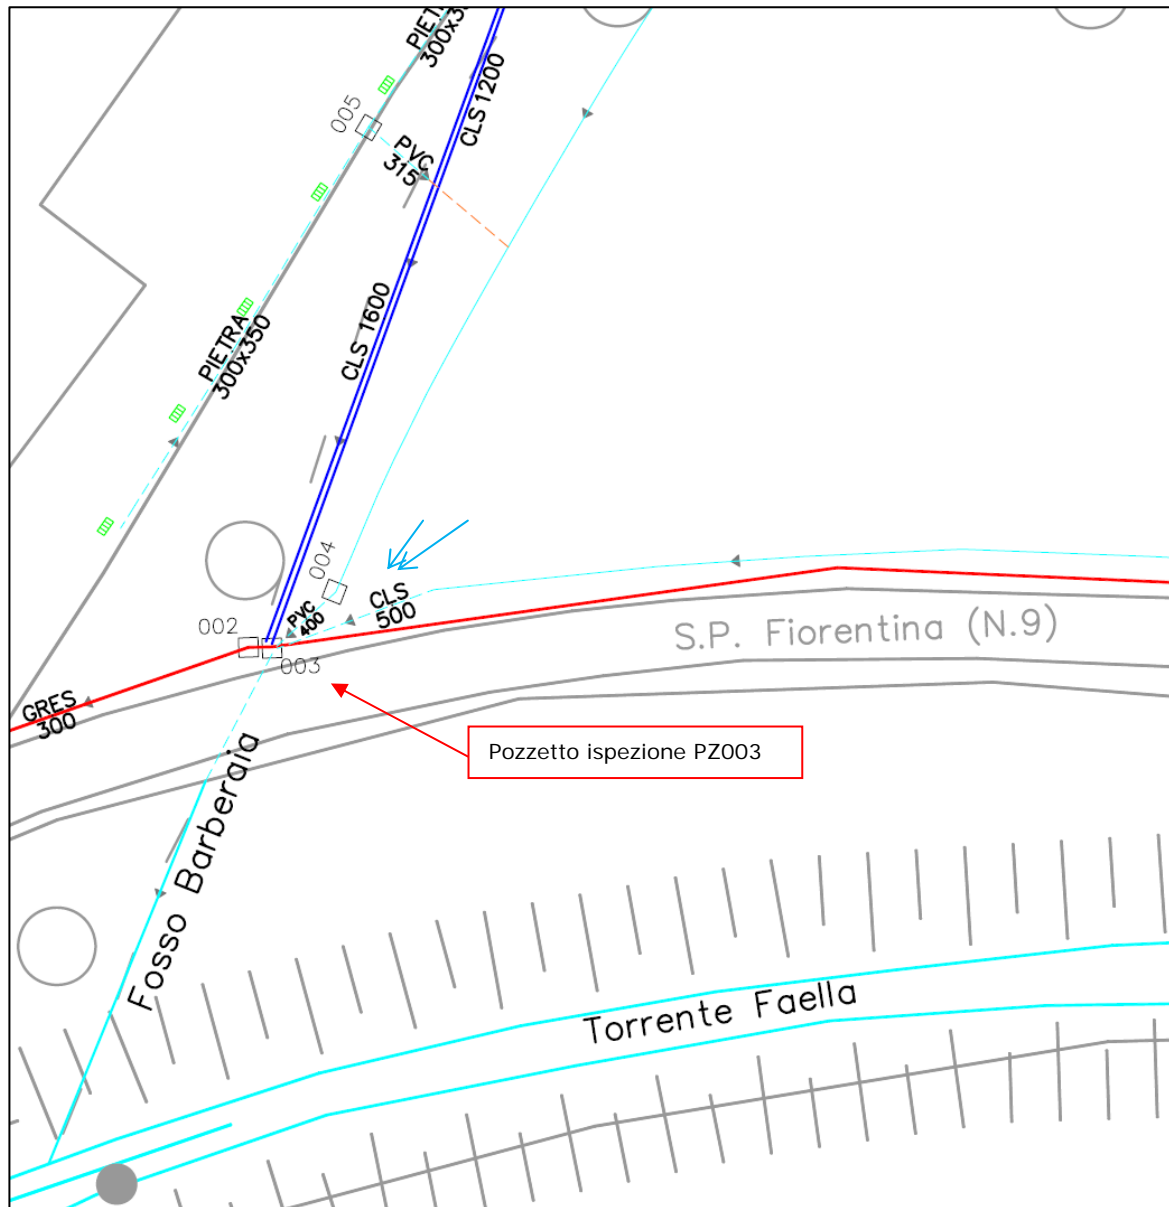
Planimetria sistema di scolo – dettaglio attraversamento/pozzetto collegamenti idraulici.
